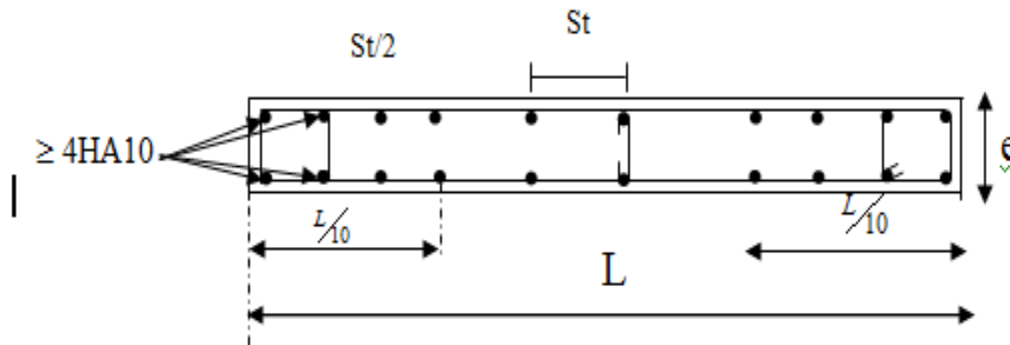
Disposition des armatures verticales dans les voiles
